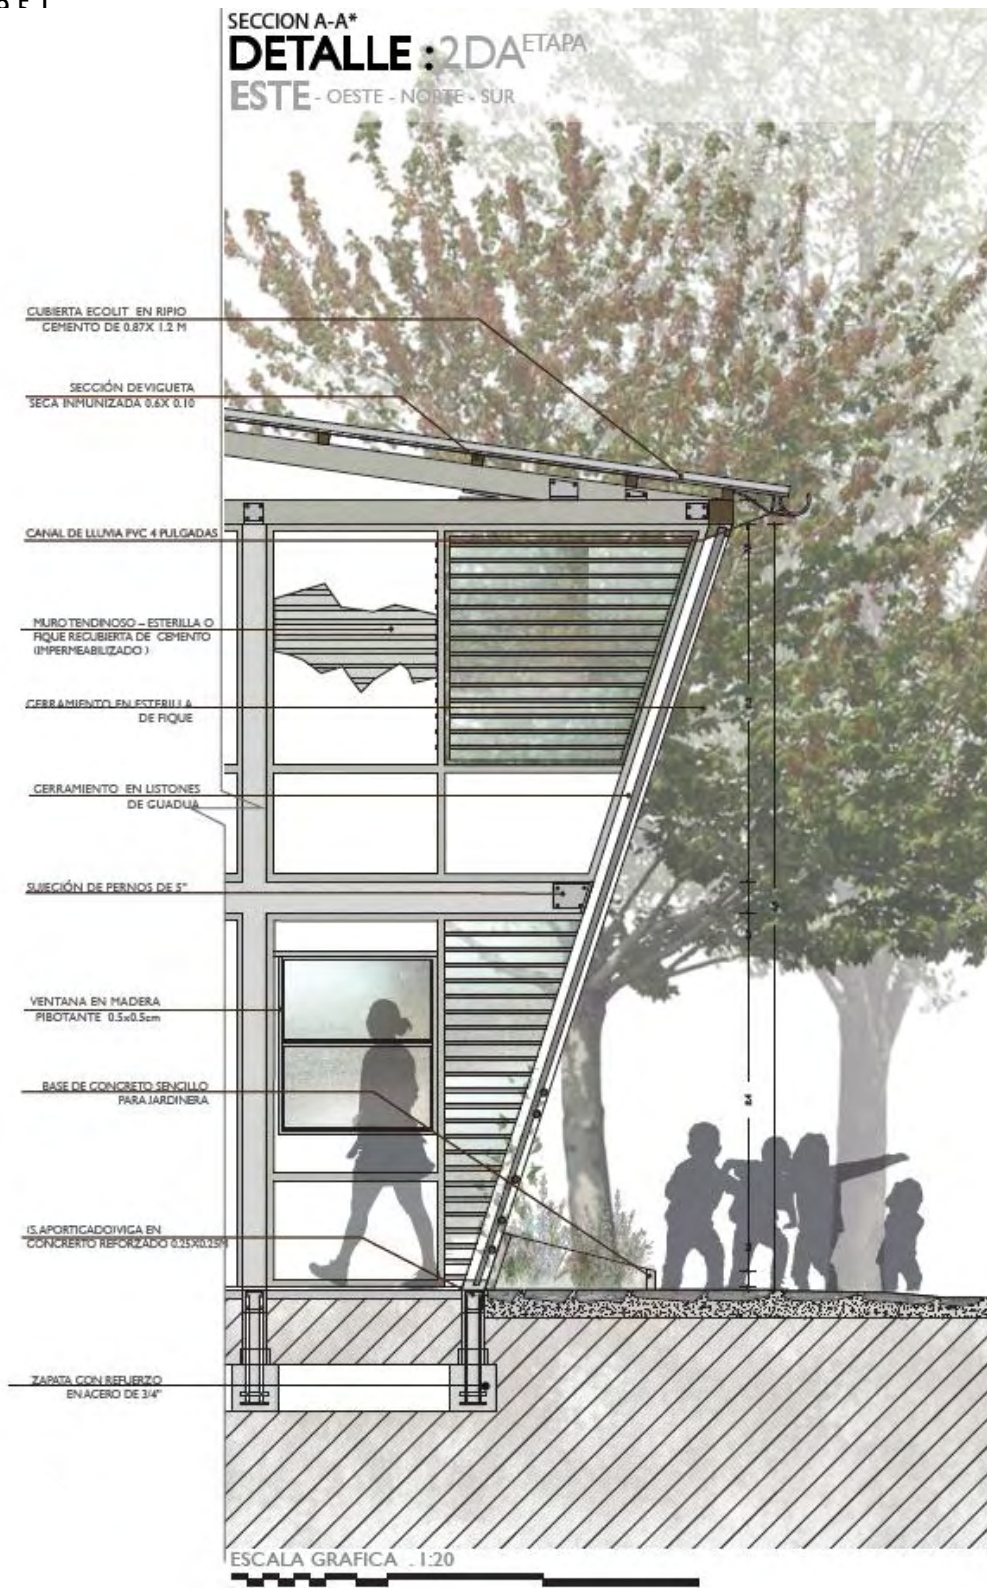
Detalle 2da etapa Este vivienda A2Fuente: propia
